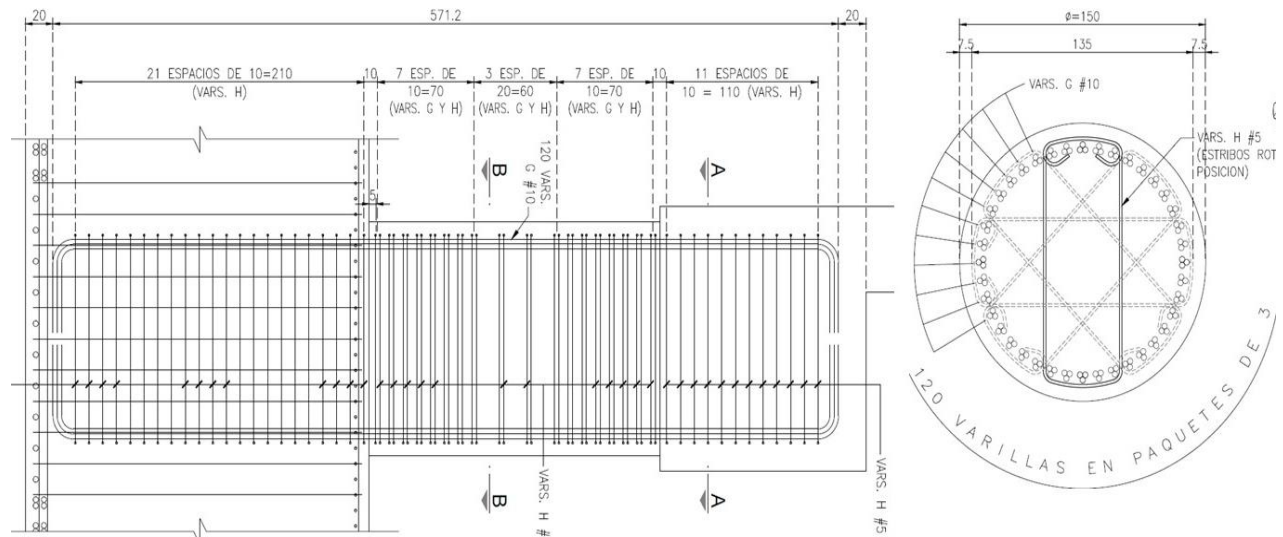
ARI Ingeniería (2023) "Arreglo de armado de acero de refuerzo para columnas de estribos (Apoyo 1 y 24)"
